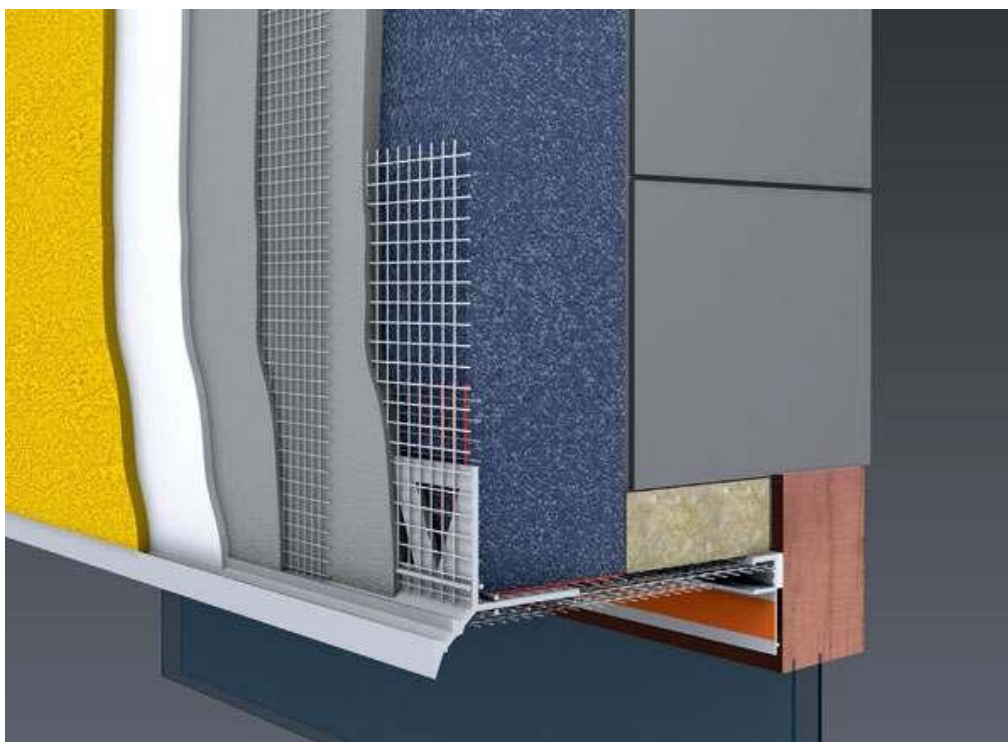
SCHÉMA NADPRAŽÍ, PARAPETU A OSTĚNÍ
